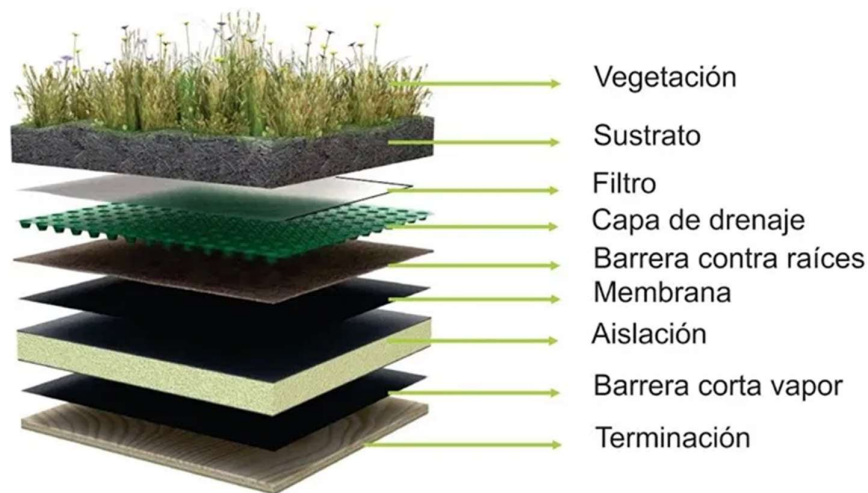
Estructura de las capas de las cubiertas verdes (Fuente: www.sudsostenible.com/).
